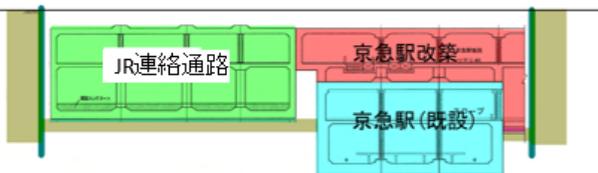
掘削部 (第4バスプール部 駅舎部) 断面図
